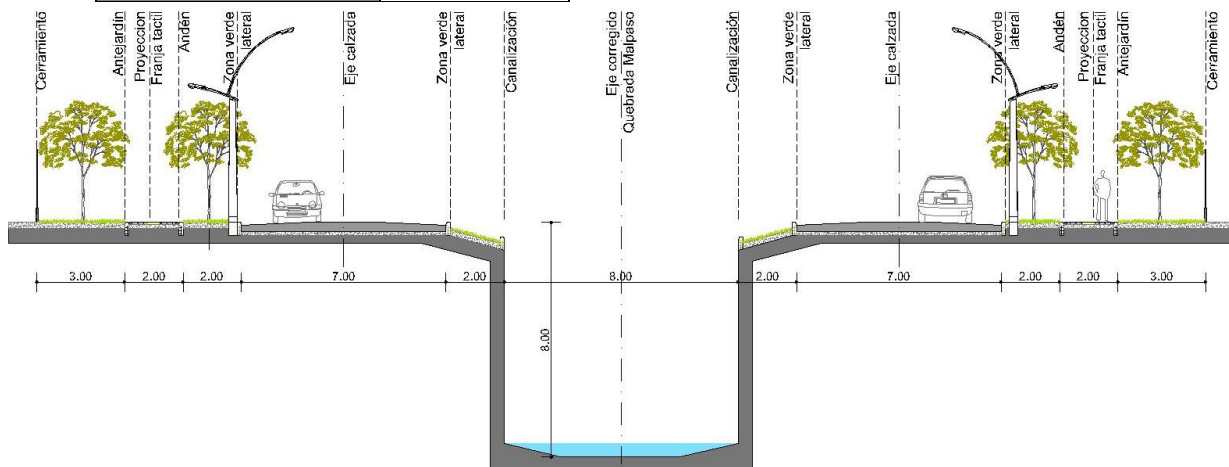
Propuesta Sección Canalización Quebrada Malpaso
